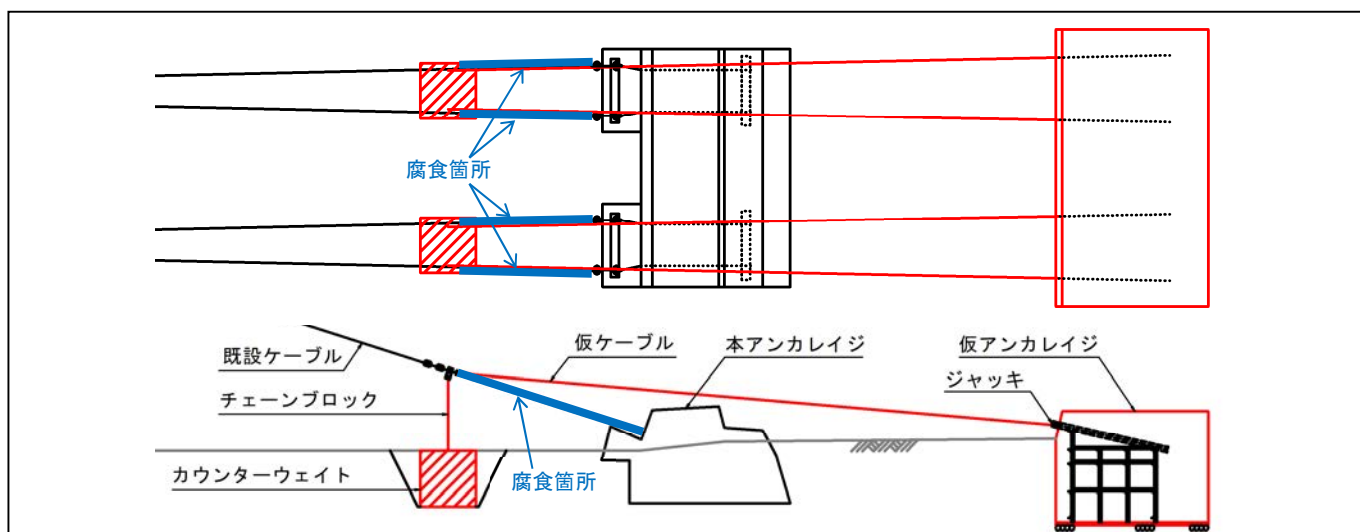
鉛直と水平の2方向に仮ケーブルを設置する場合(上:平面図, 下:側面図)
